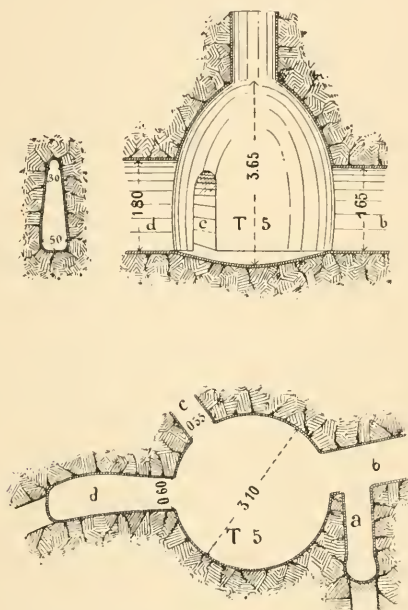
Grundriss und Durchschnitt des alten Brunnens T 5.
